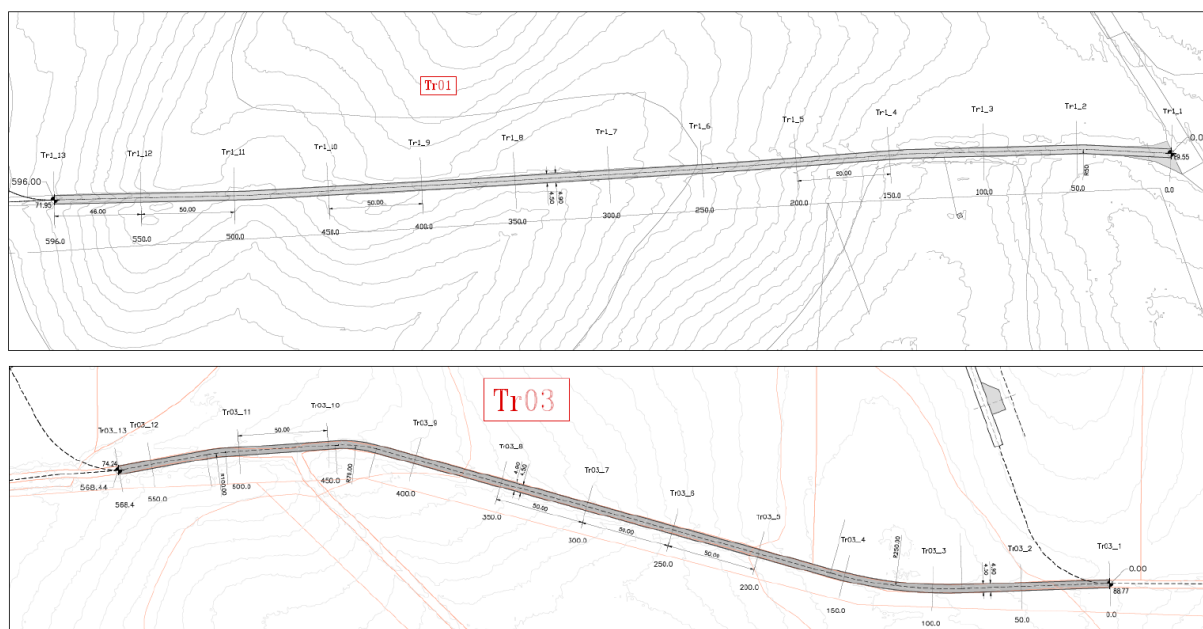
Stralcio planimetrico degli adeguamenti della Strada Ponte dell'Abbadia in progetto – Tratti Tr01 e Tr03
